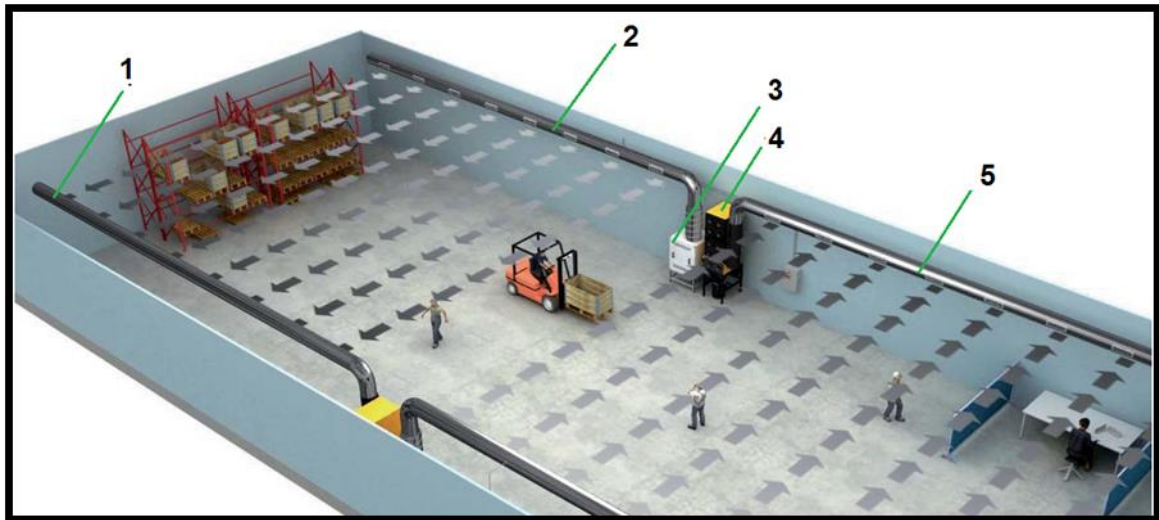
Sistema de Ventilación Push-Pull, Taller Escuela Industrial - Fuente: <http://www.plymovent.com/es/aspiracion-humo-soldadura-y-corte/productos/humos-de-soldadura-y-corte/sistema-push-pull/sistema-push-pull>
